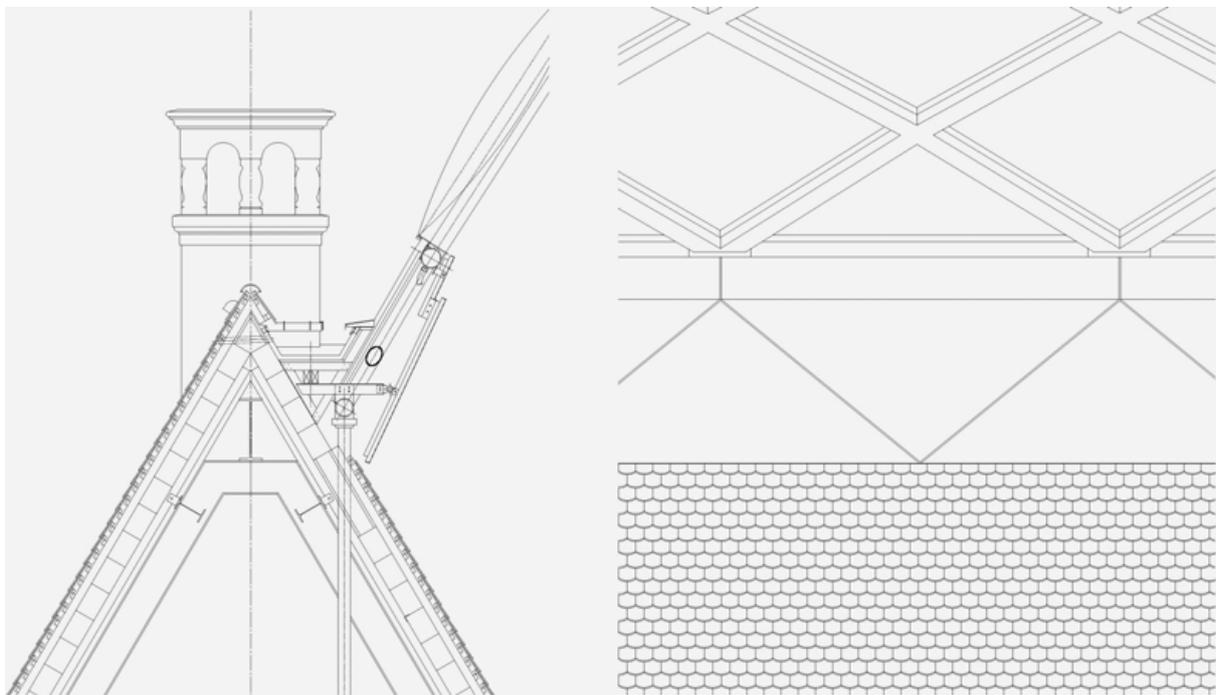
Schnitt und Ansicht des Anschlusses der Stabwerkskuppel an die bestehende Dachkonstruktion
